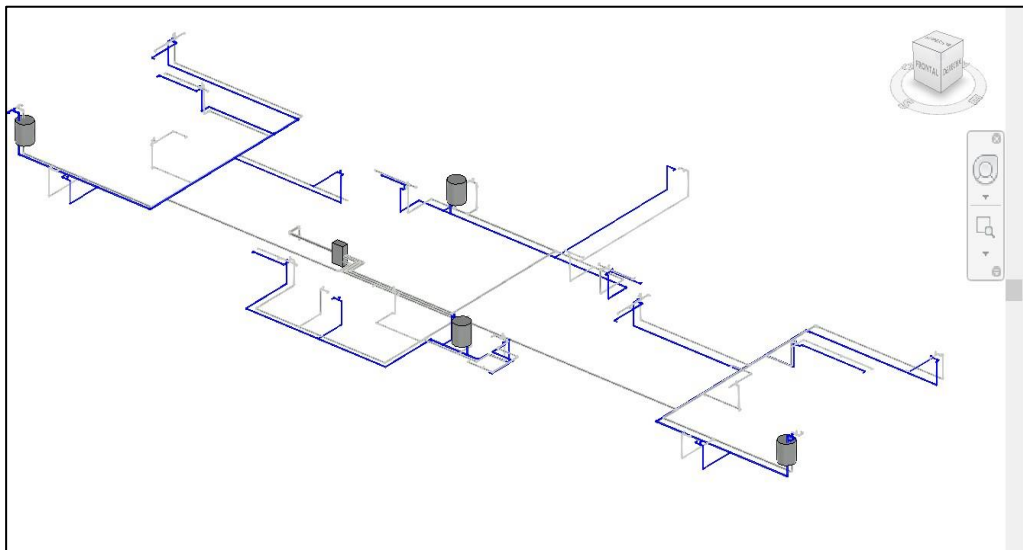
Distribución 3D de AAPP caliente y fría plantas altas
